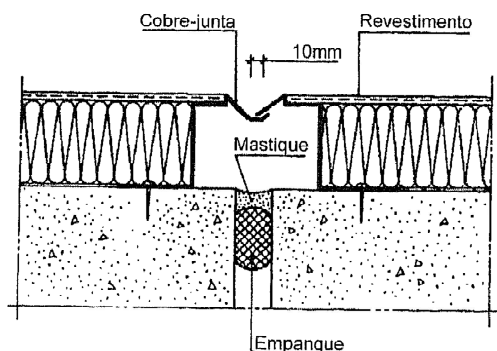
Tratamento de junta de dilatação assegurando a estanquidade da alvenaria [19]
